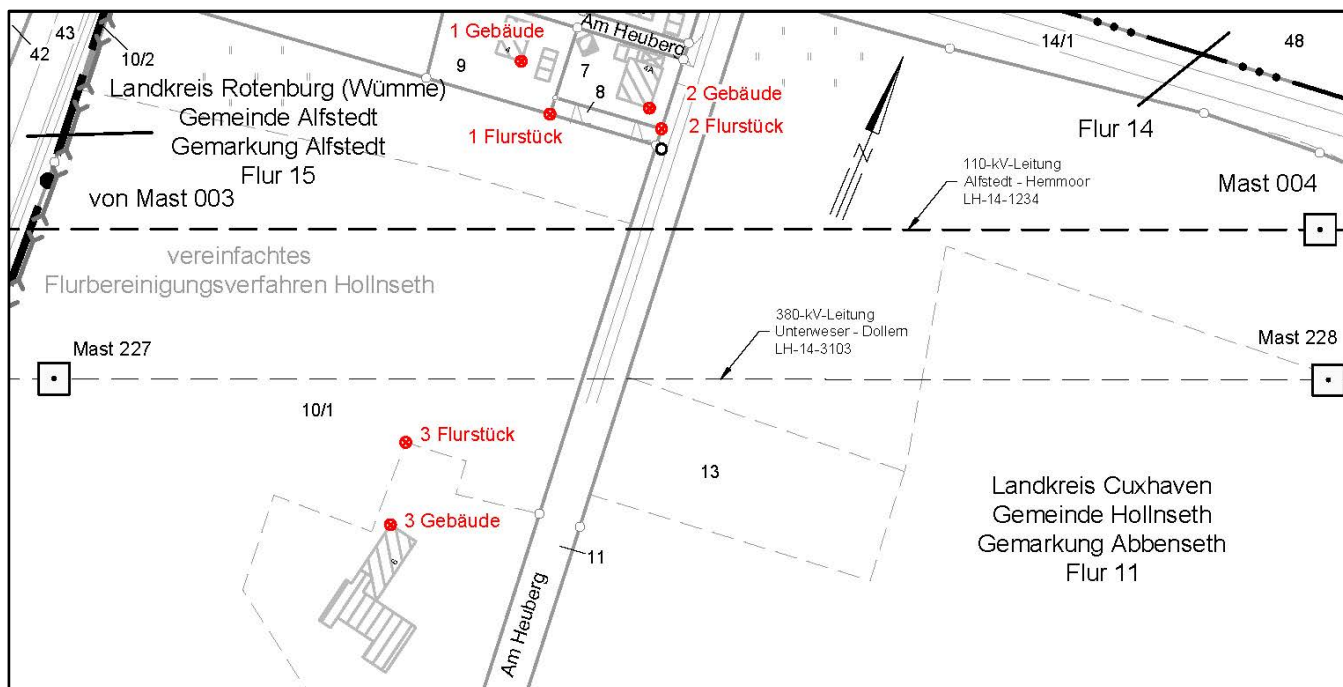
Lageplanausschnitt Mast 003 bis Mast 004 der 110-kV-Leitung Alfstedt - Hemmoor, LH-14-1234
